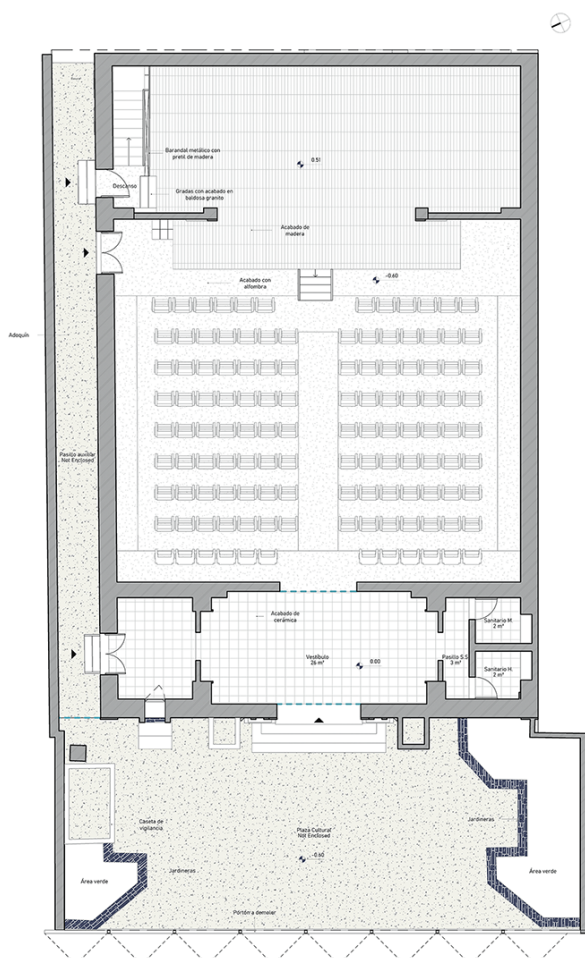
Planta arquitectónica de la situación existente. Fuente: modelo de elaboración propia
